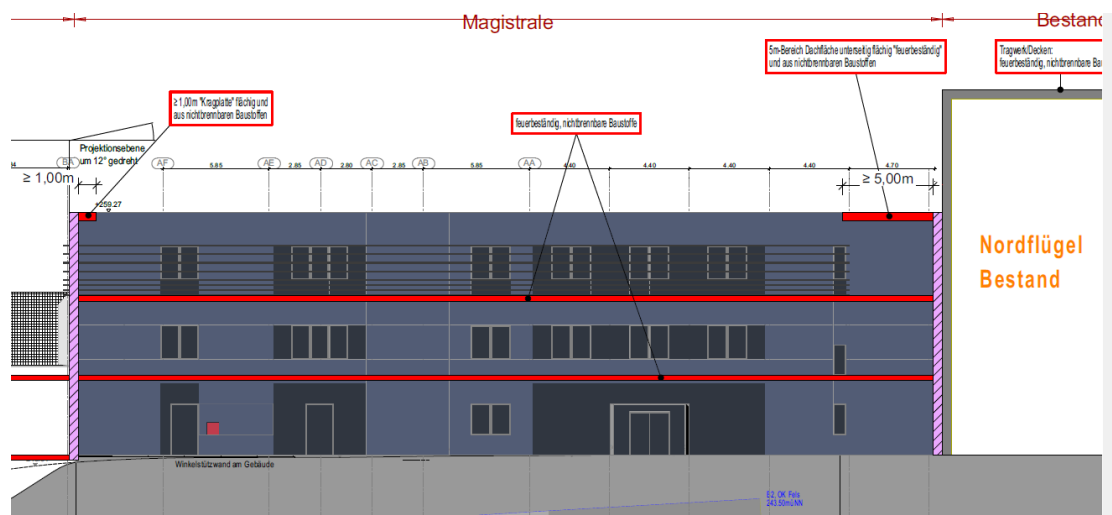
Ausschnitt BS-Plan (Schnitte/Ansichten)
